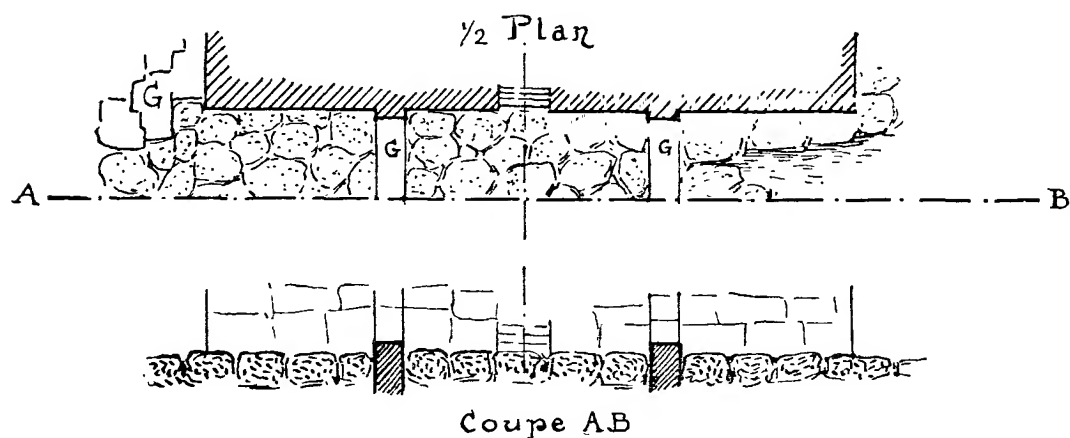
Plan et coupe sur le passage central de la porte Ouest de Ta Prohm.
